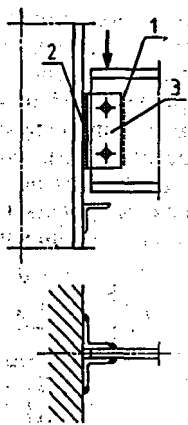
Гибкое (полужесткое) прикрепление балки к колонне (схема):
